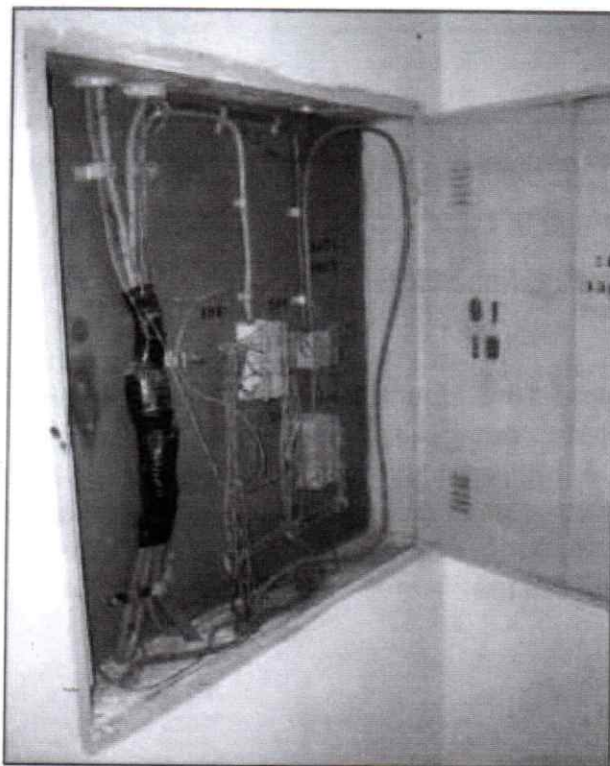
Caixa de distribuição de telefonia - 2º pavimento.
